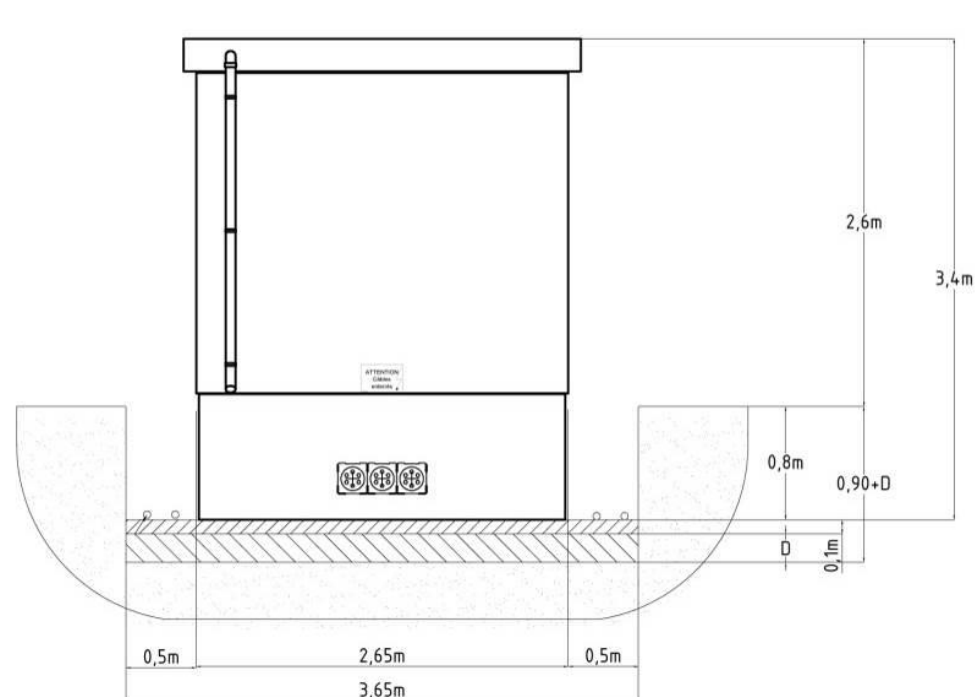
Plan de façade d'un poste de livraison (vue de profil)
